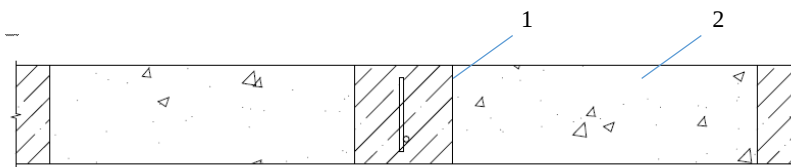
Фрагмент сборно-монолитного перекрытия с газобетонными блоками:
